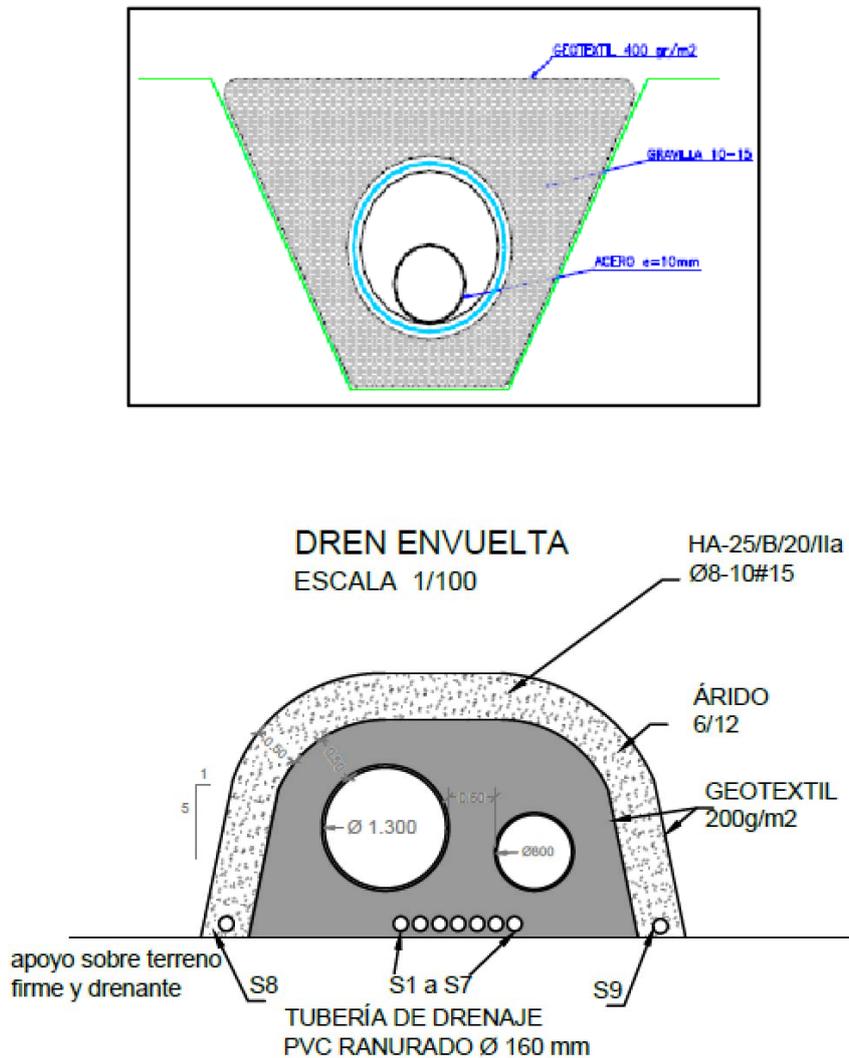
Sección tipo de drenaje de fondo y dren envuelta
